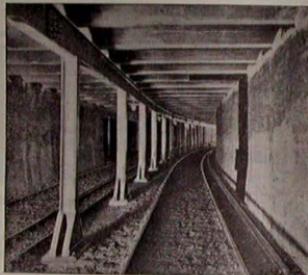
Ferrovia elevata e sotterranea di Berlino vista del tunnel.
